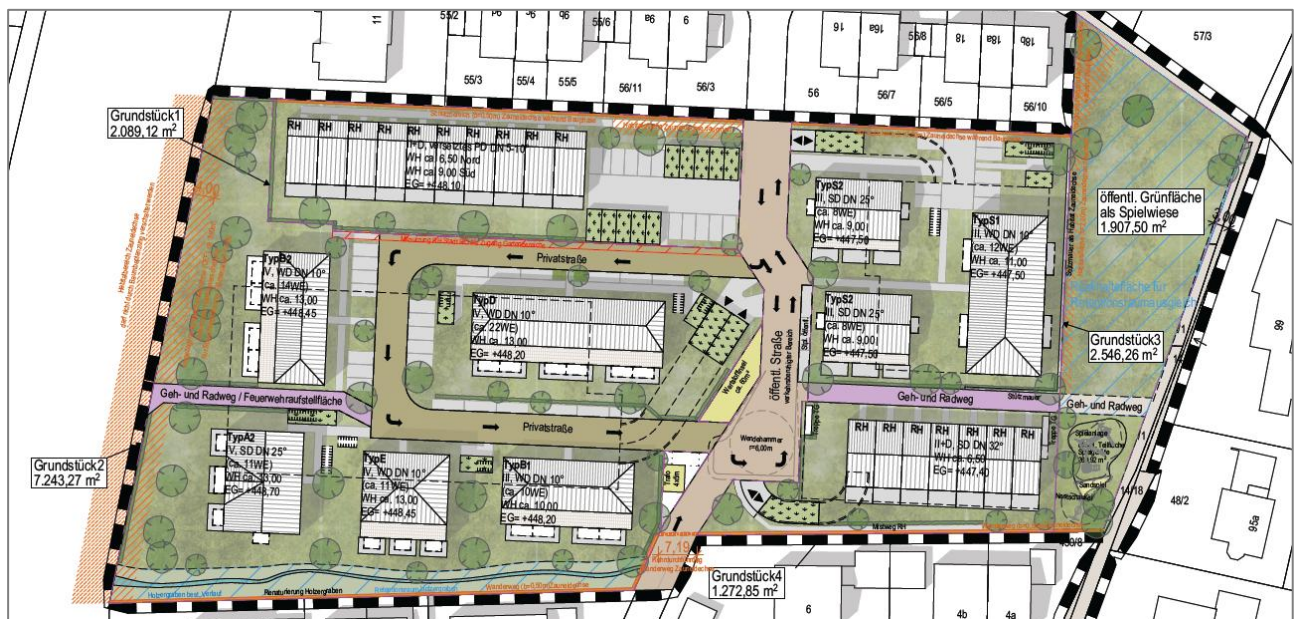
Geplante Verdichtung des B-Plans „Möslstraße“, Quelle: Planungsgruppe Strasser
